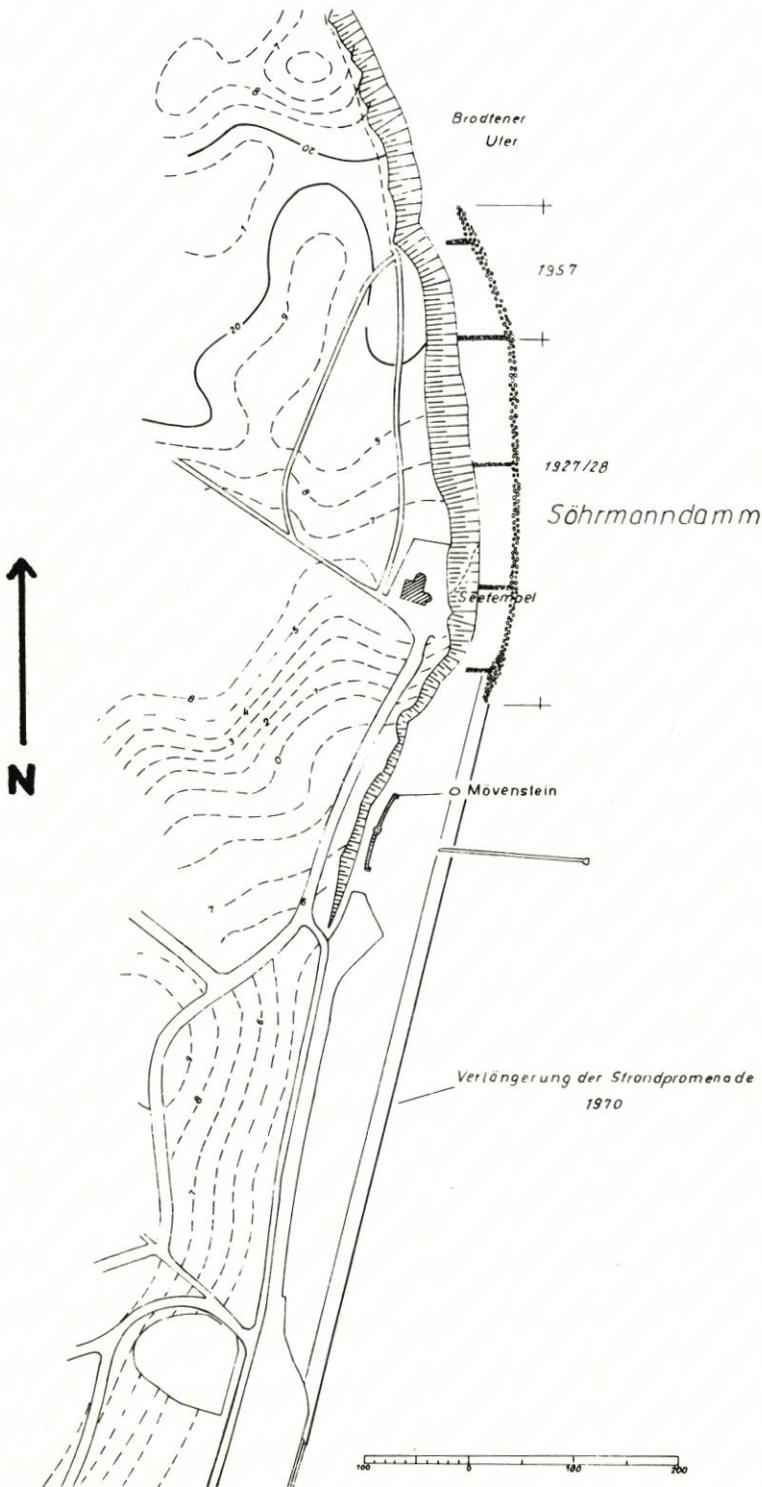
Lageplan des Söhrmandammes vor dem Brodtener Ufer
